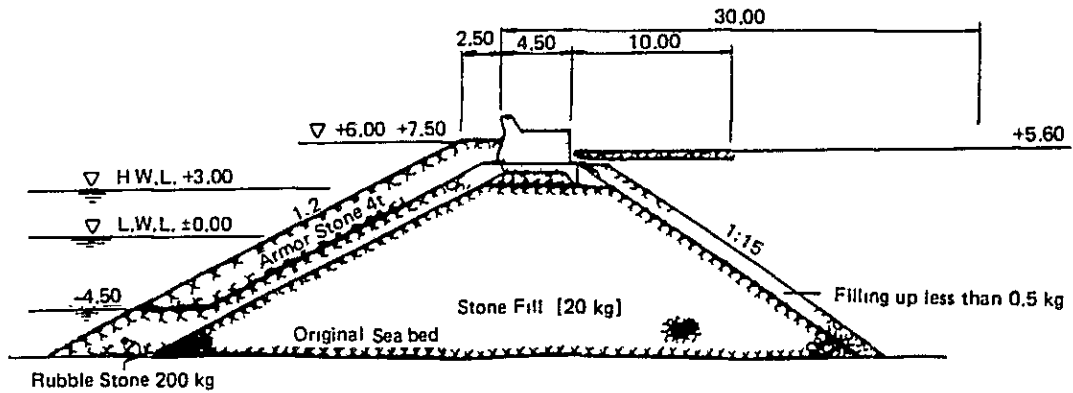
(1) 1:10 碼頭標準斷面圖
